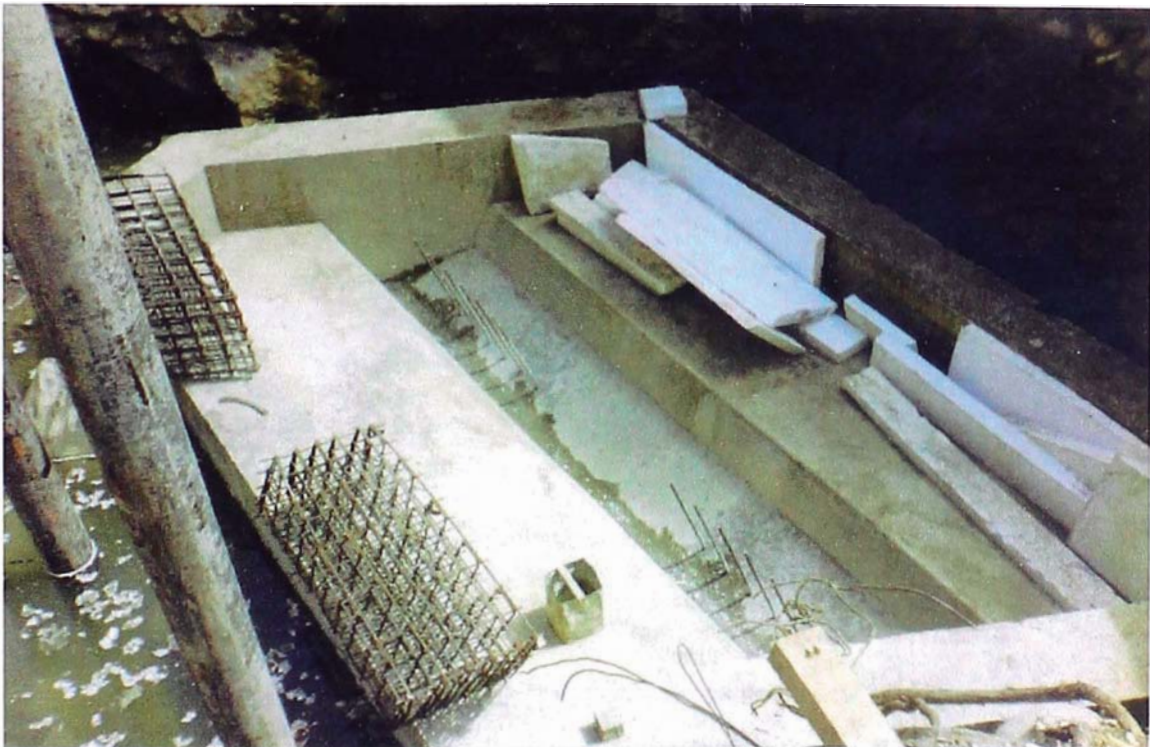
Cimentación de la margen izquierda, con aceros $\varnothing 3/4"$ colocados y canastillas listas para su colocación.
